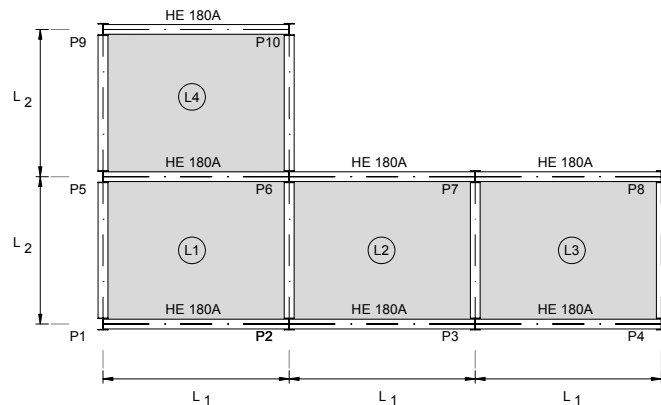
Planta do pórtico 3D de referência com assimetria em planta
